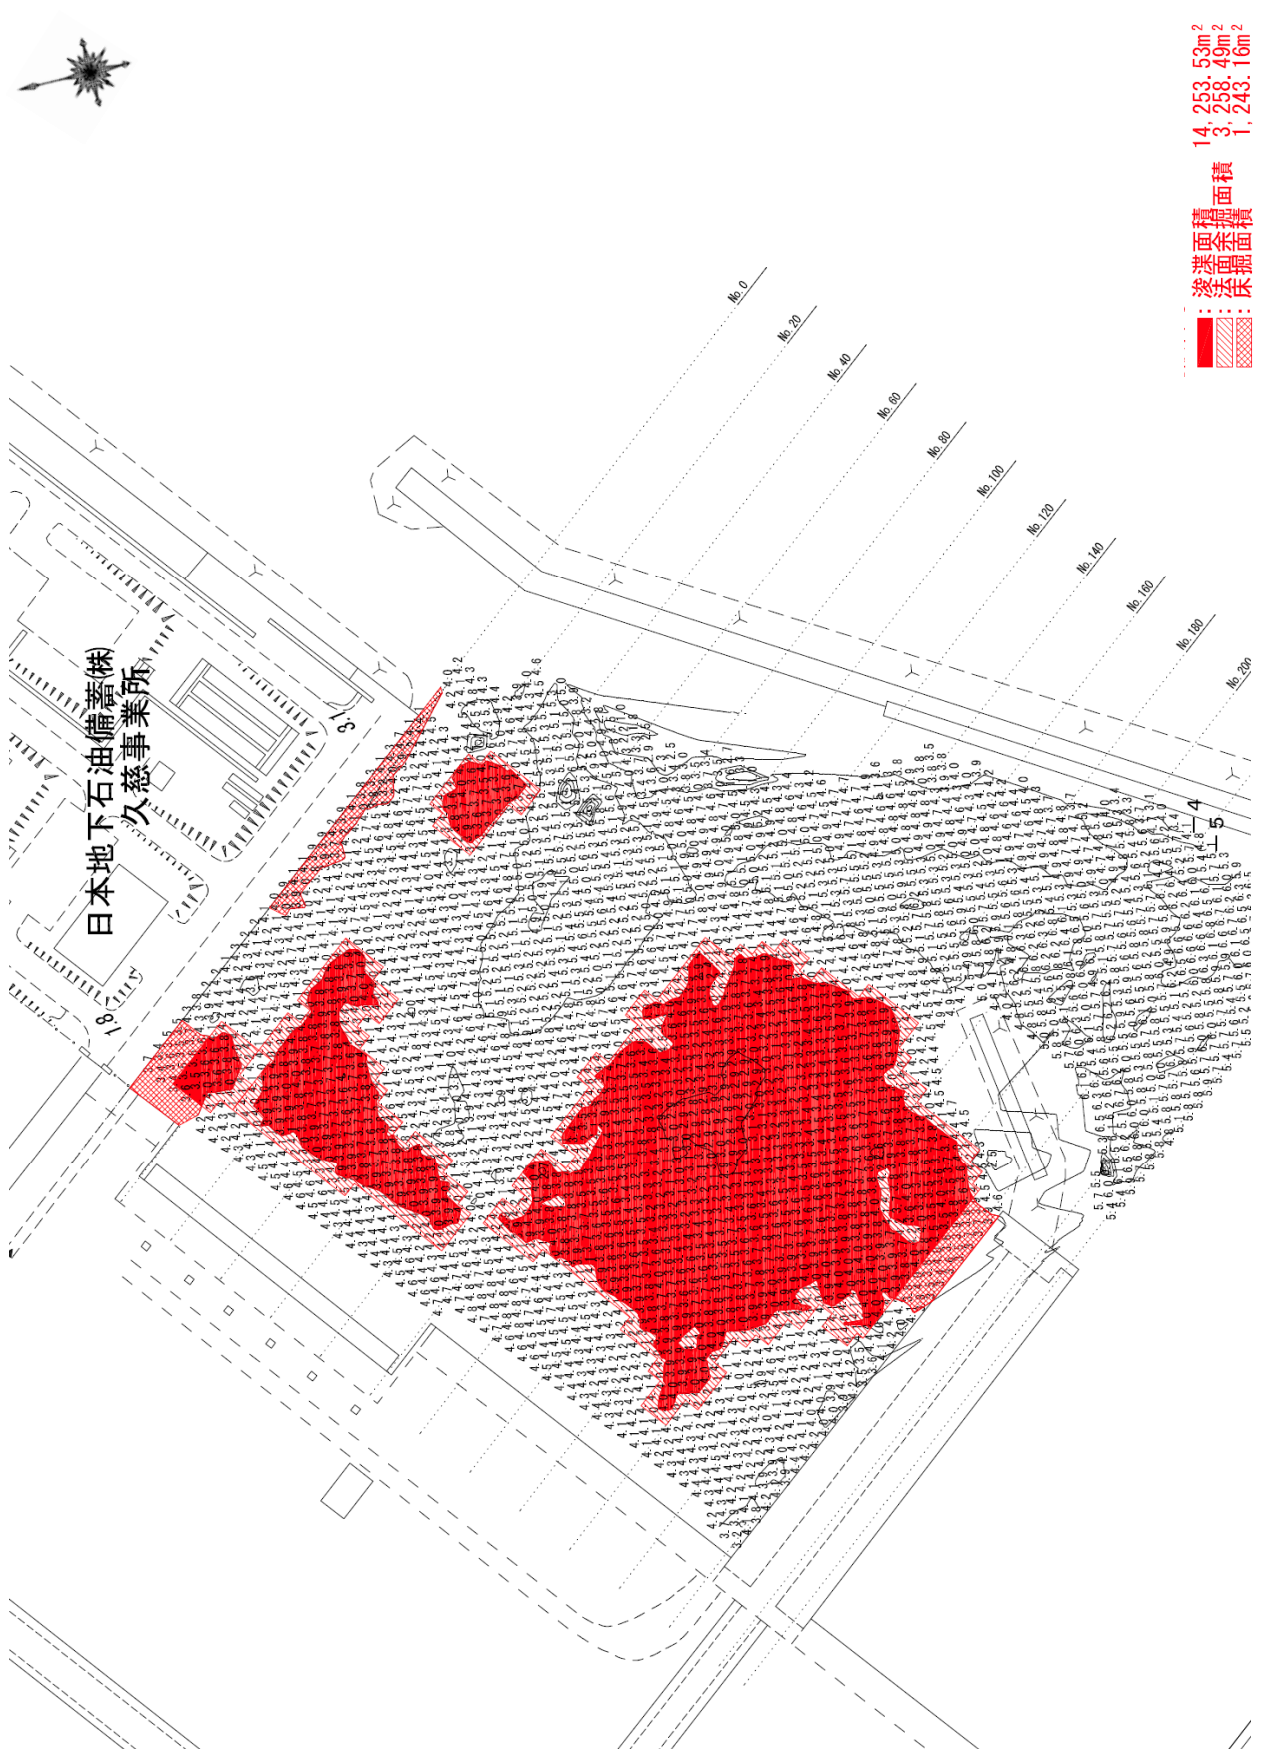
No.1 半崎地区_1号泊地埋設堆積状況平面図（被災後）
